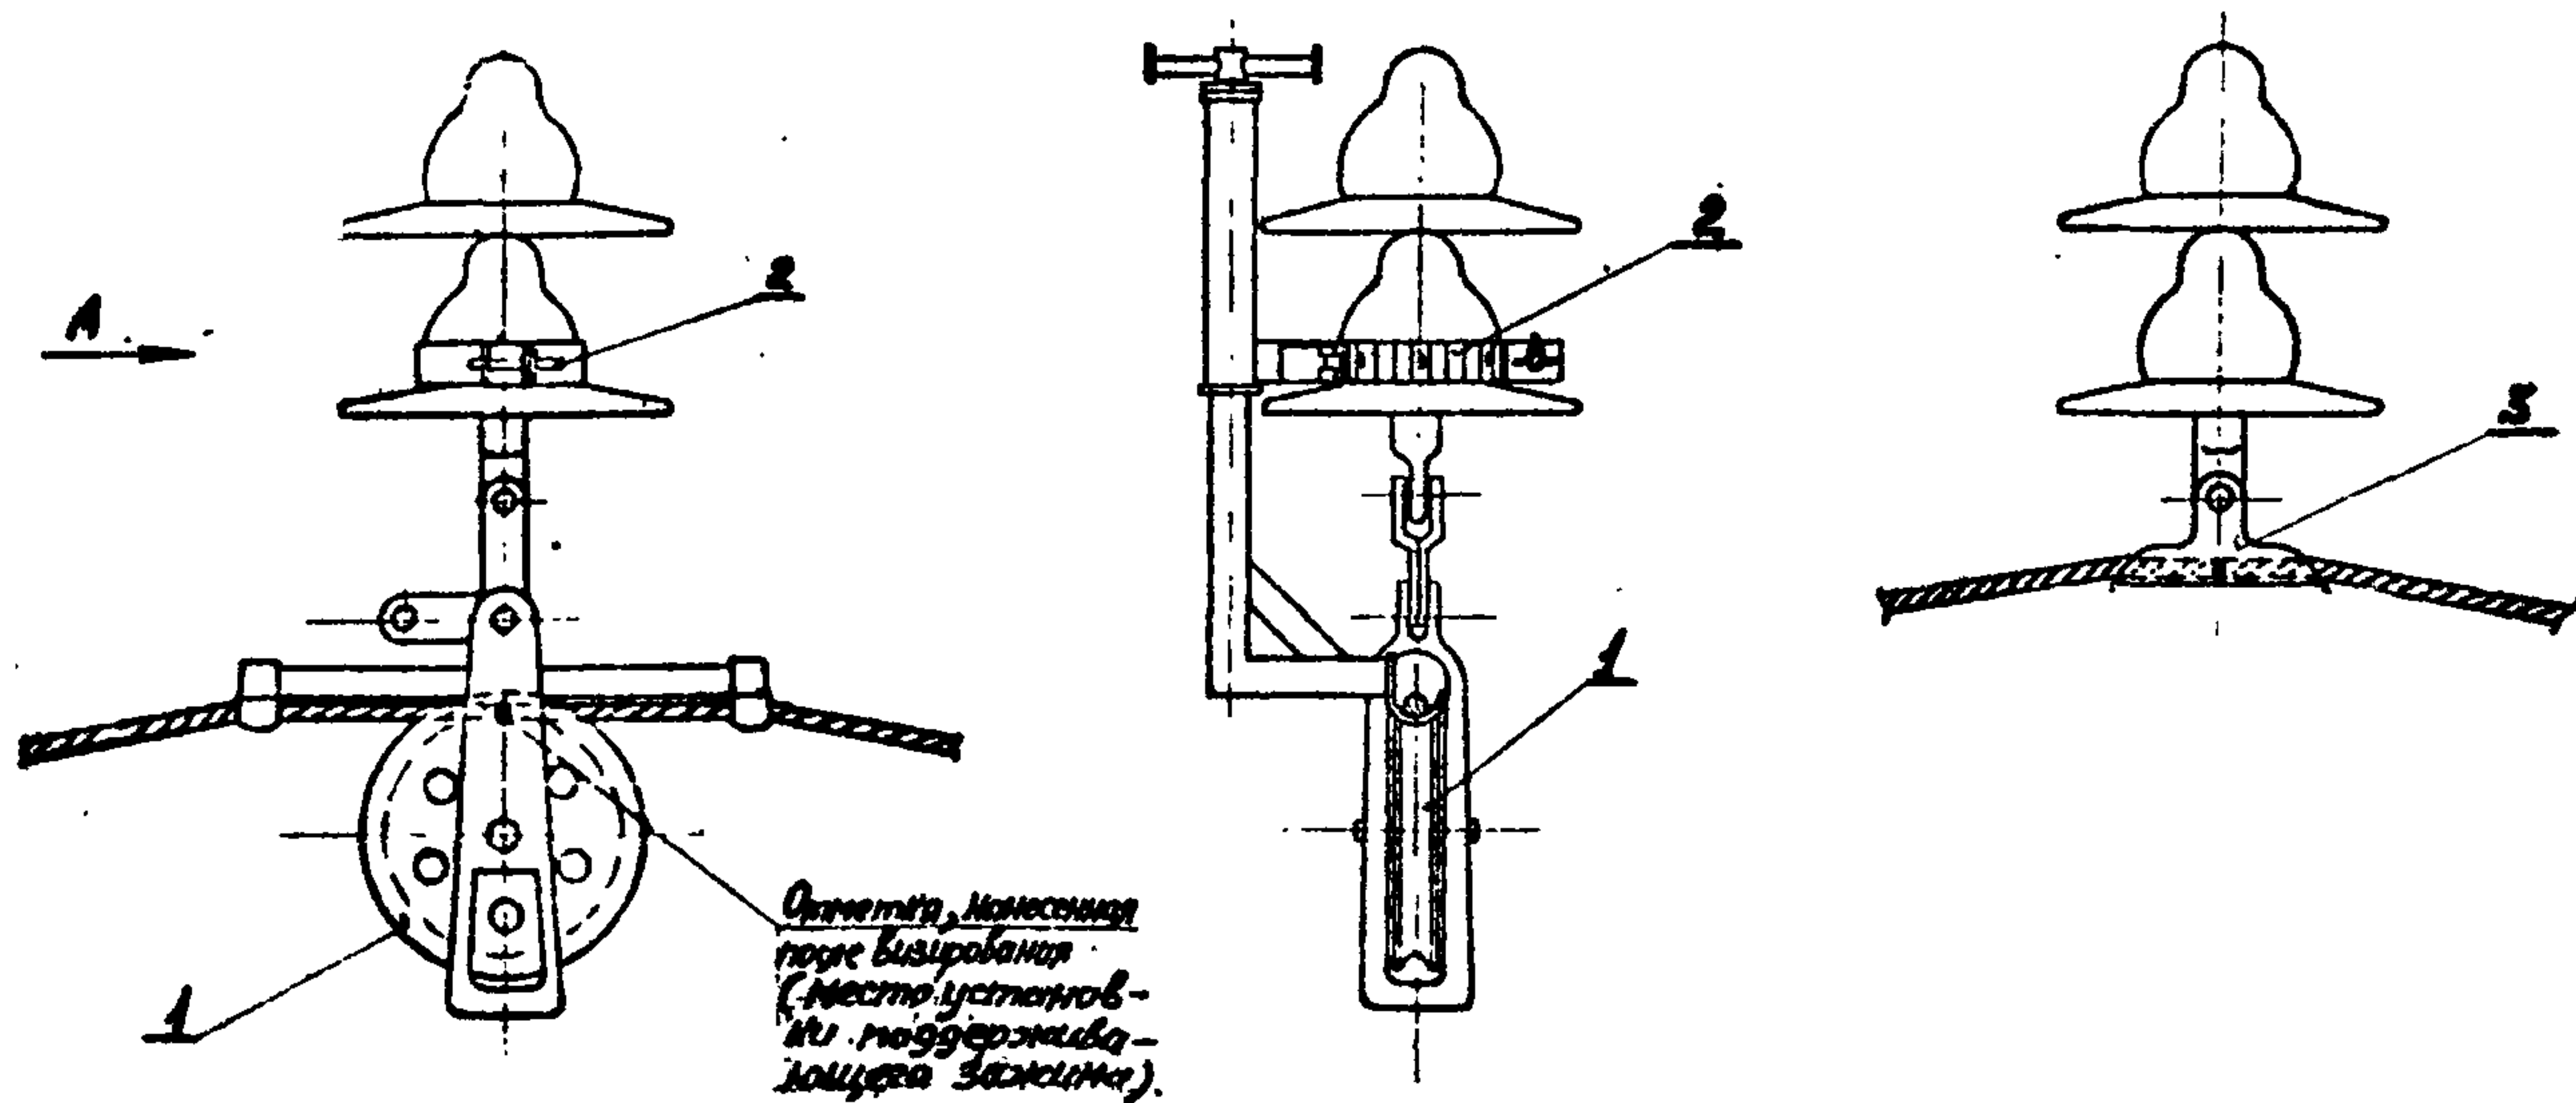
Узел А. Перекладка провода из раскаточного ролика в поддерживающий зажим
